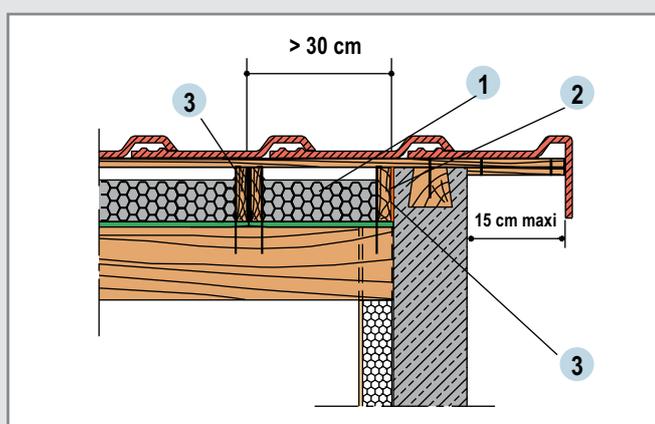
Débord en pignon avec panne non traversante (panneau de butée de largeur > 30 cm)
